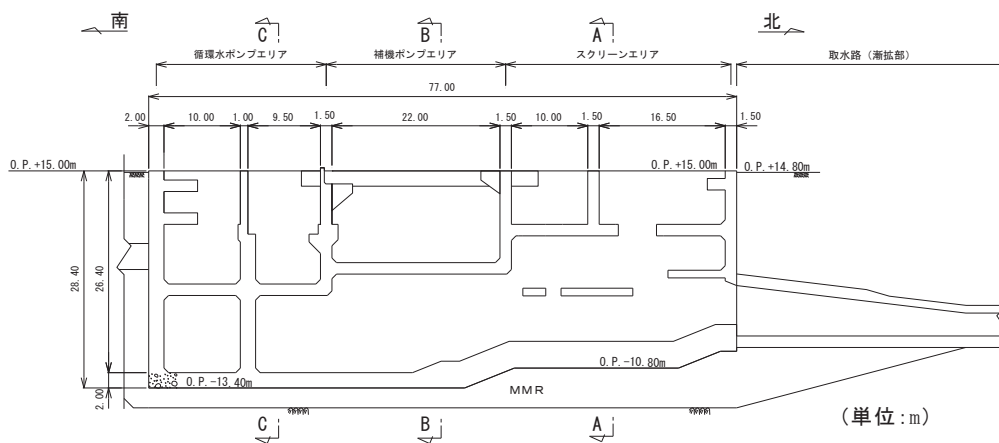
海水ポンプ室断面図 (E-E 断面, 南北)
